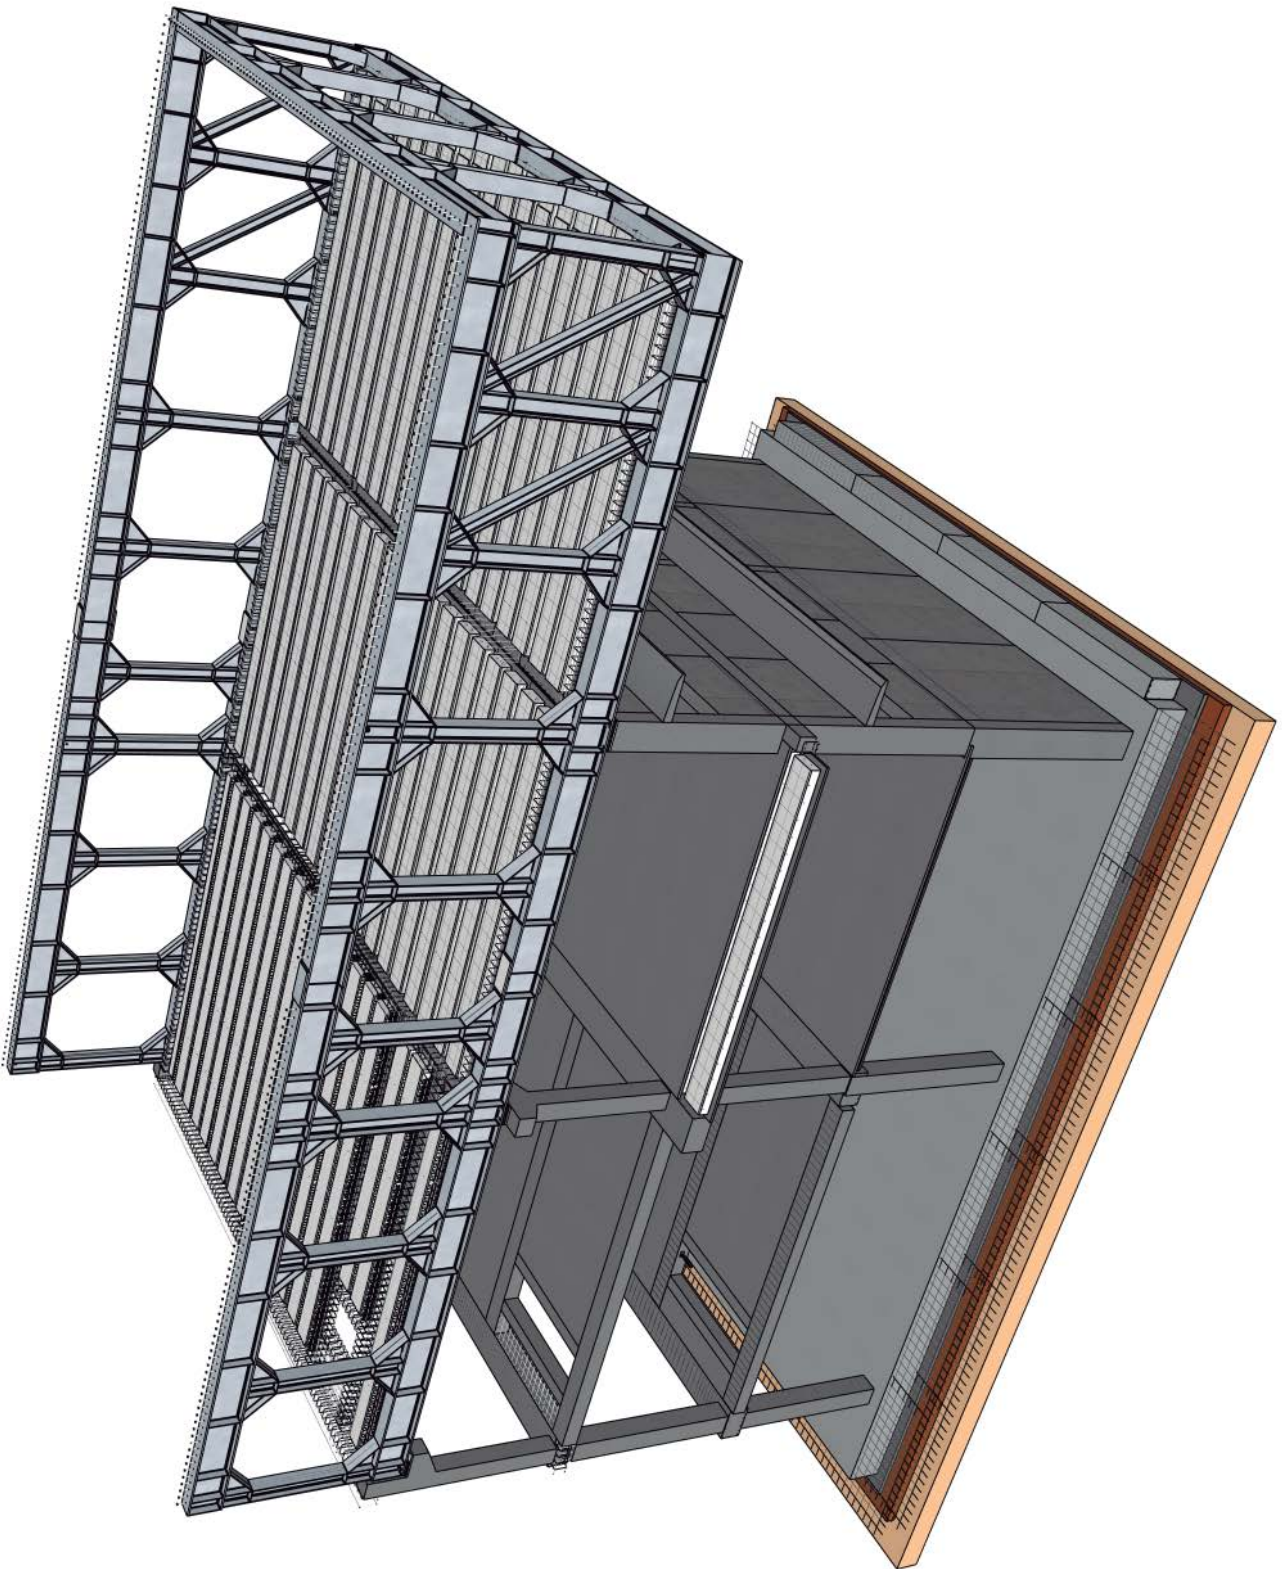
Colocación de las prelosas del forjado en el voladizo
